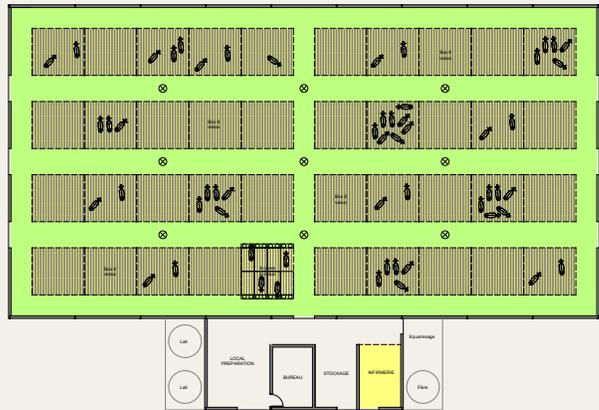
VUE EN PLAN D'UN BÂTIMENT TYPE TUNNELS DE VEAUX DE BOUCHERIE EN CAILLEBOTIS
